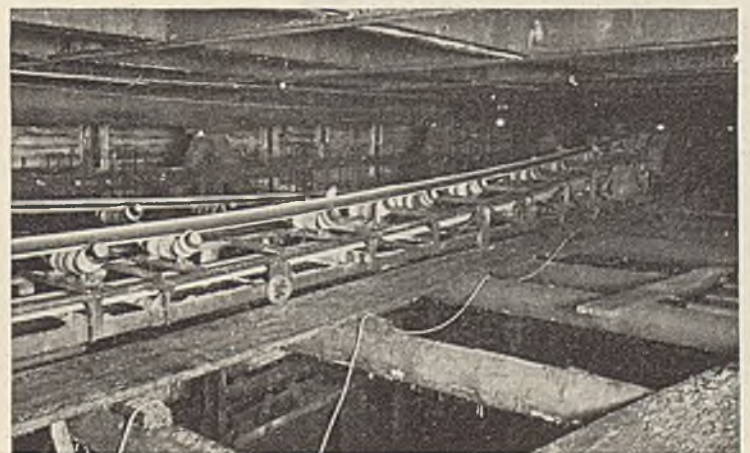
Ortsfestes und bewegliches Band auf der ersten Steifenlage im Tunnelabschnitt Brunnenstraße Berlin.
